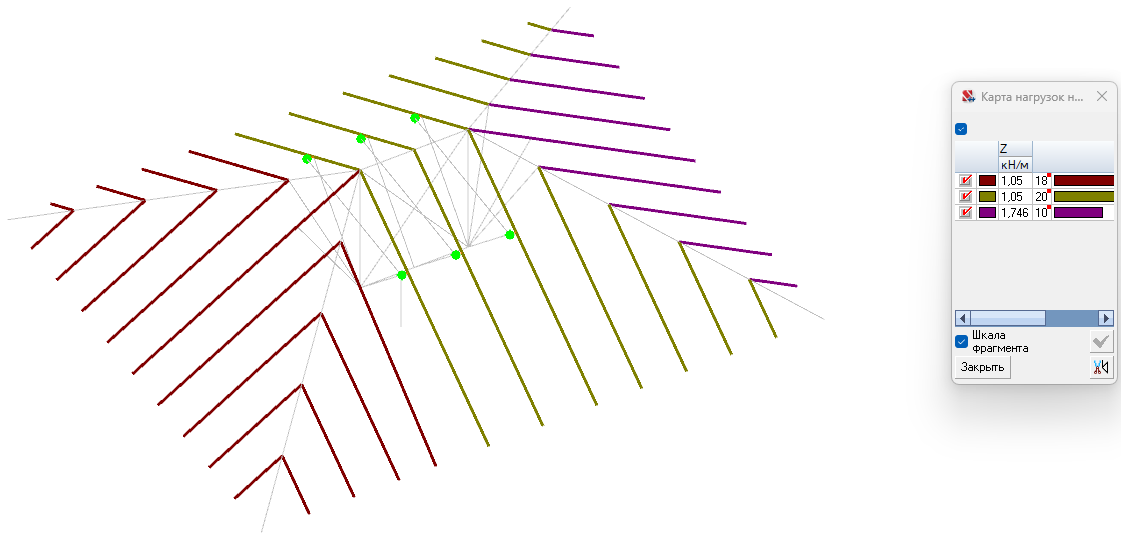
Снеговая нагрузка вариант 3
